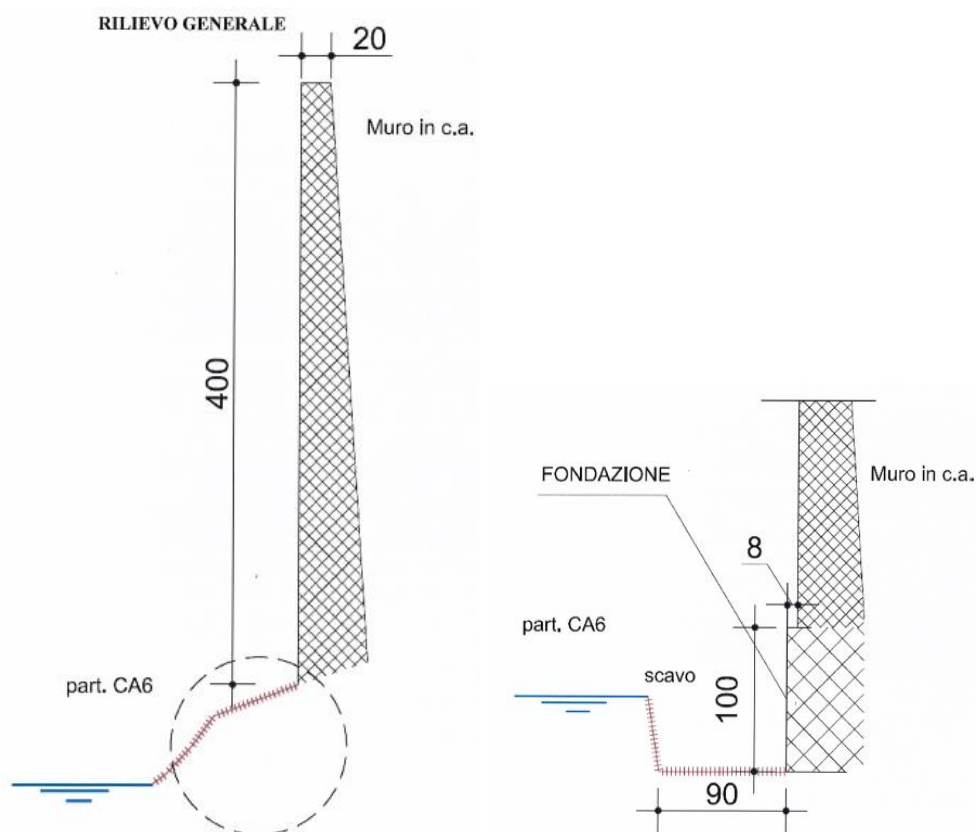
Sezione tipologica strutturale rilevata in sito
